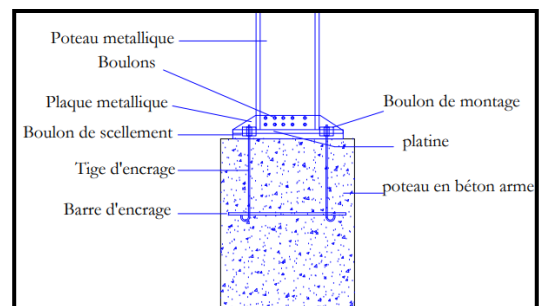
Détail 01 Articulation pied de poteau- fondation Source : auteurs
